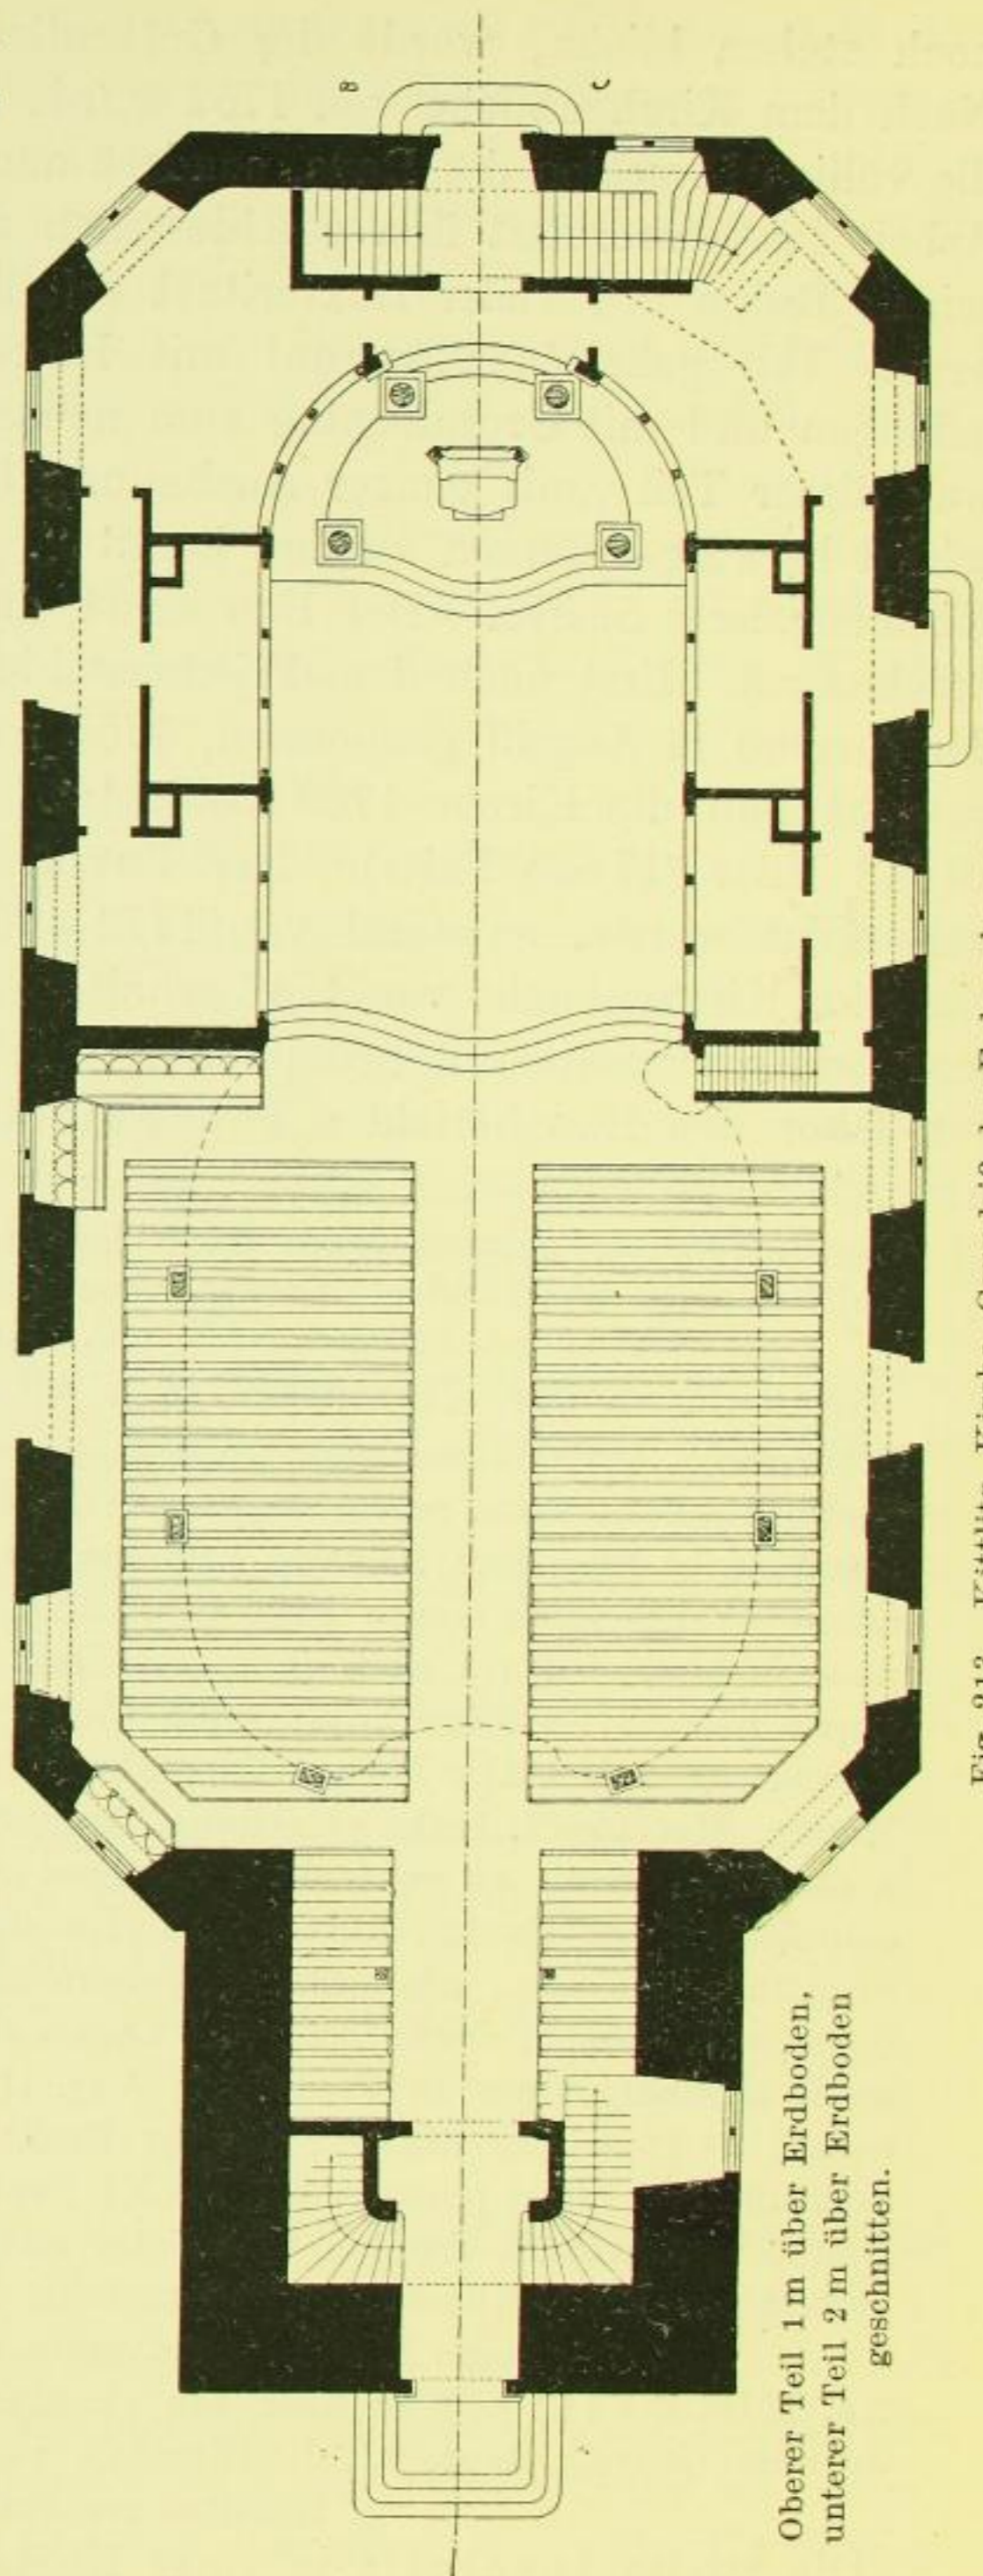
Kittlitz, Kirche, Grundriß des Erdgeschosses.
